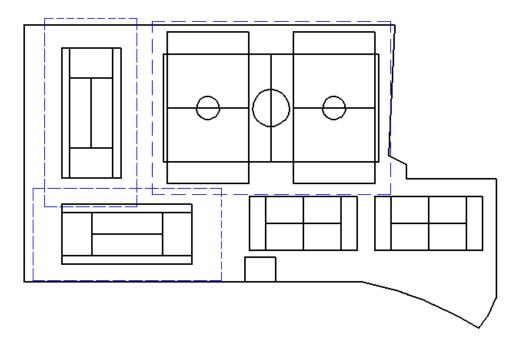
Primera propuesta de distribución para las pistas deportivas exteriores
